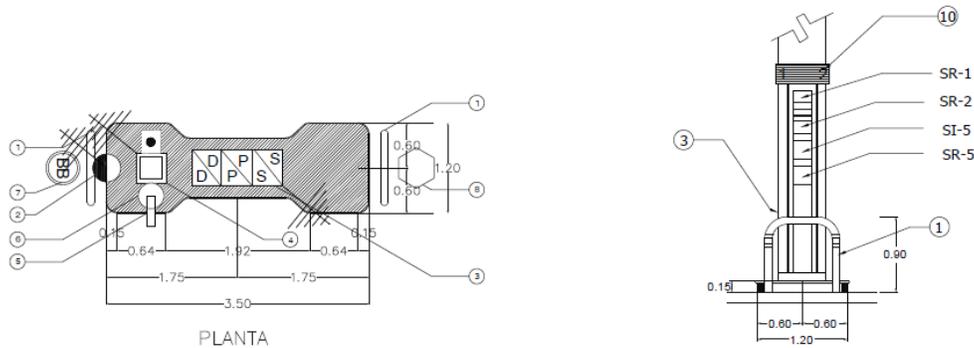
Planta y alzado lateral de módulo de abastecimiento
